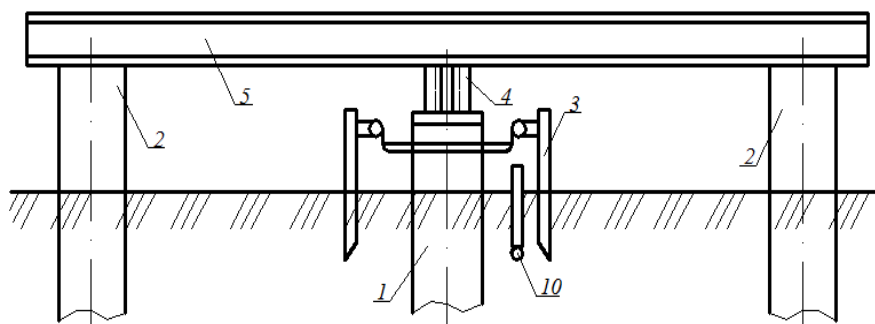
Установка с гидравлическим домкратом, системой балок и анкерными сваями
